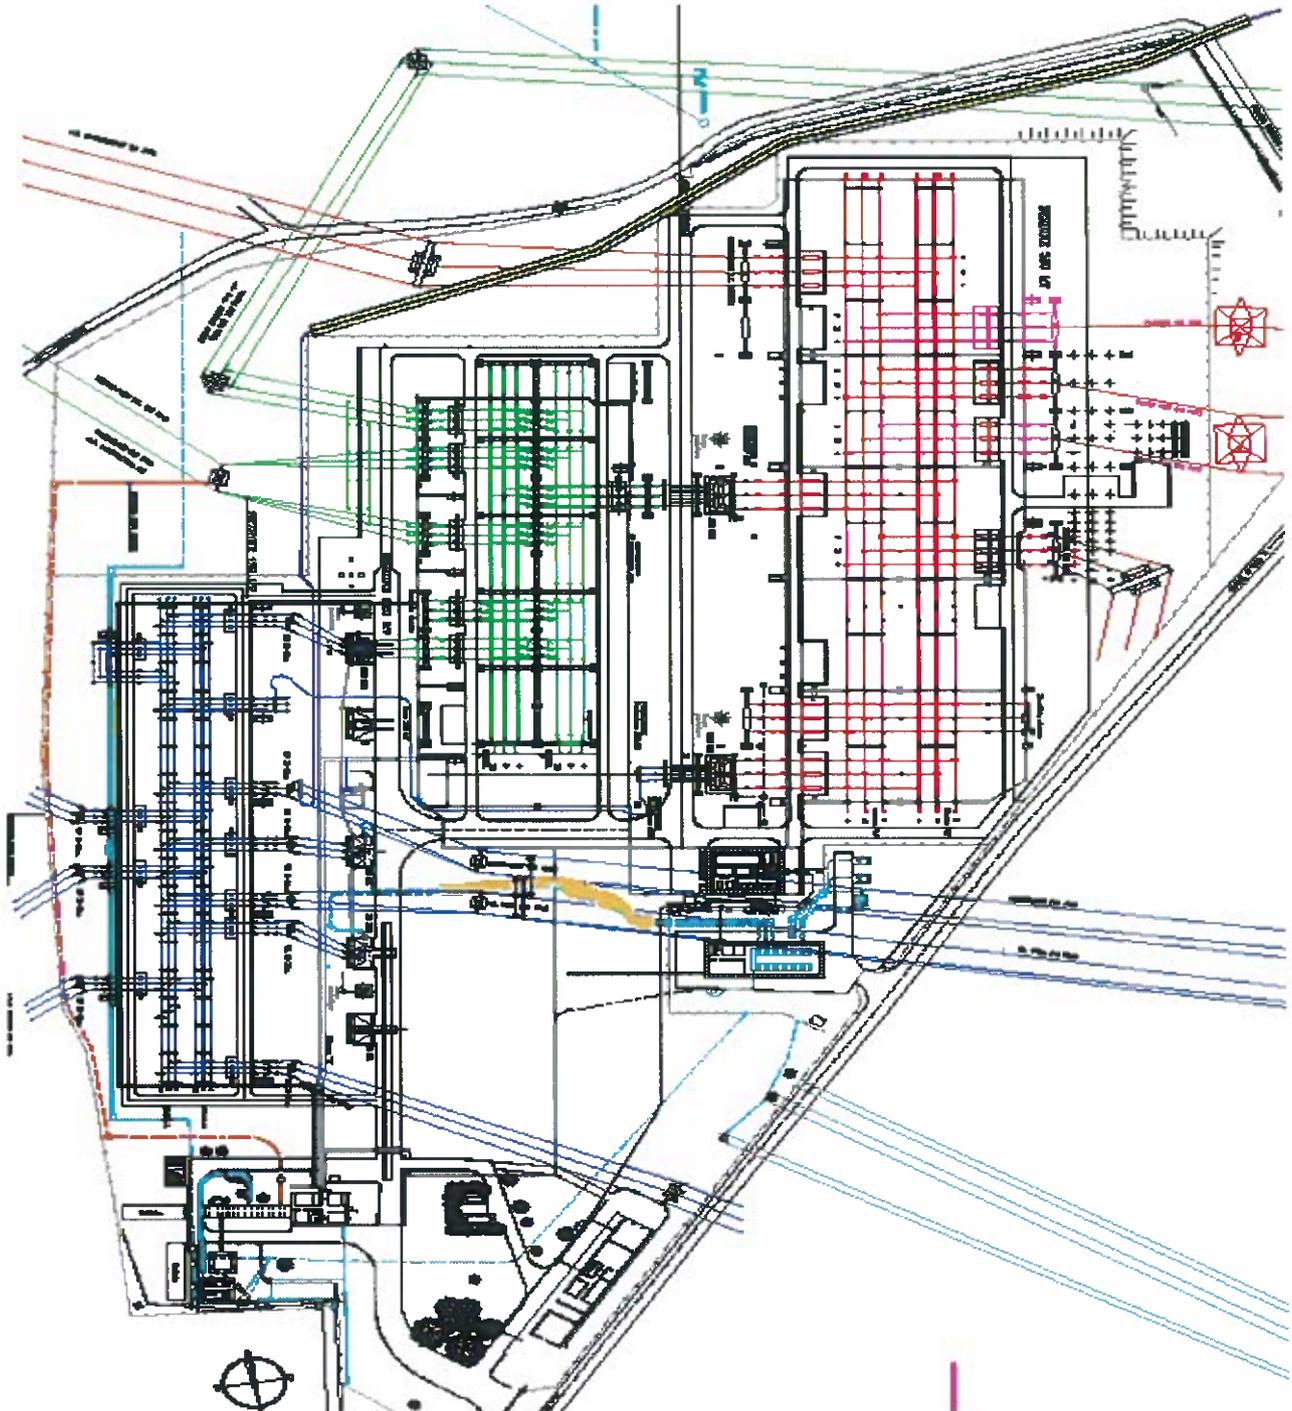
Planimetria elettromeccanica della S.E. 380/220/132 kV di Redipuglia
